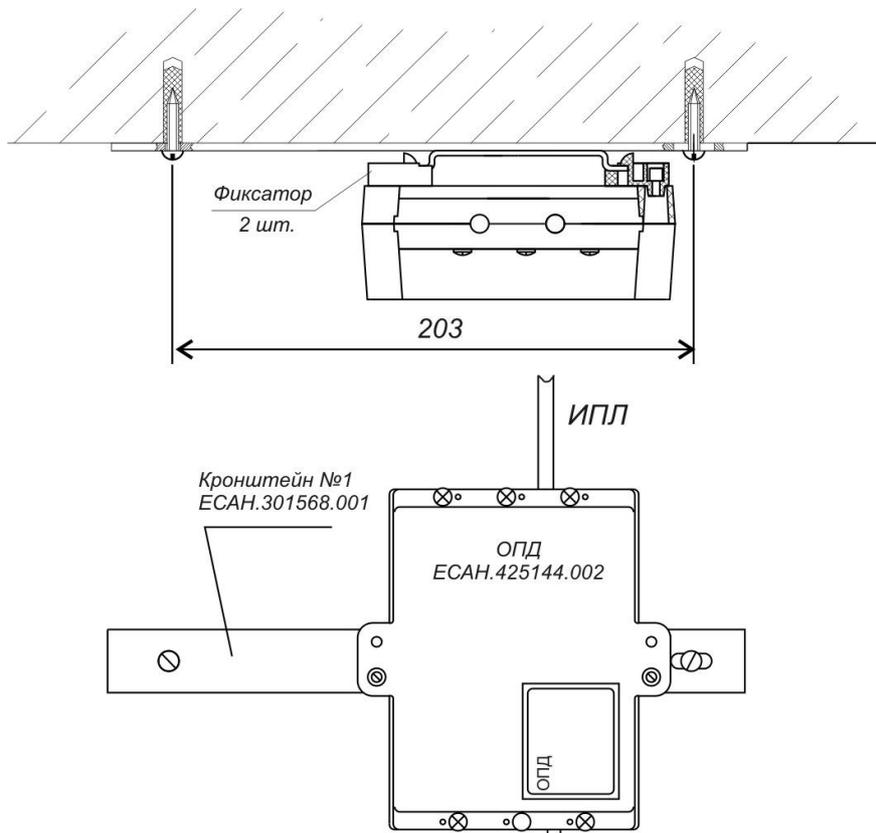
Установка ОПД и тройниковой коробки на кронштейн №1
